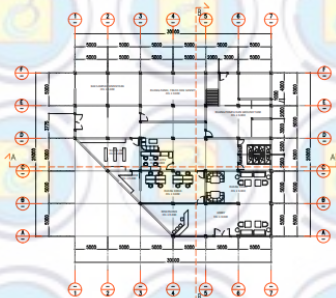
9 Denah, tampak, dan potongan massa bangunan pelayanan publik
